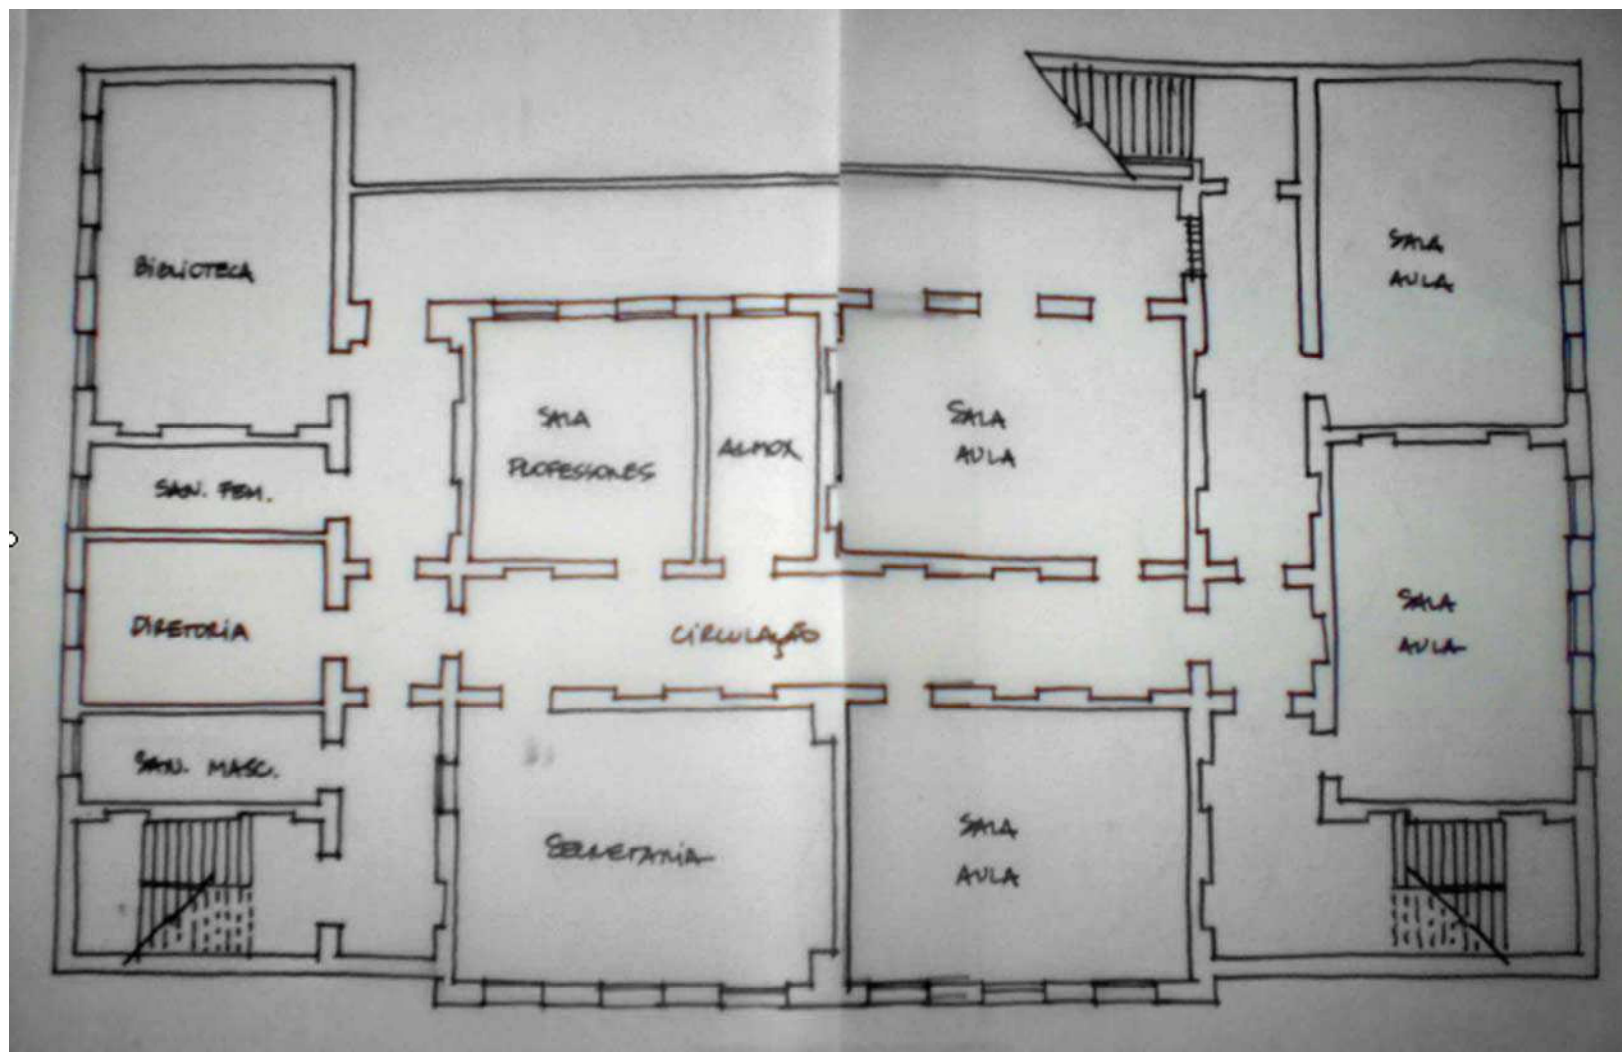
Planta do Subsolo – proposta de intervenção. Fonte: arquivo do FDE.
